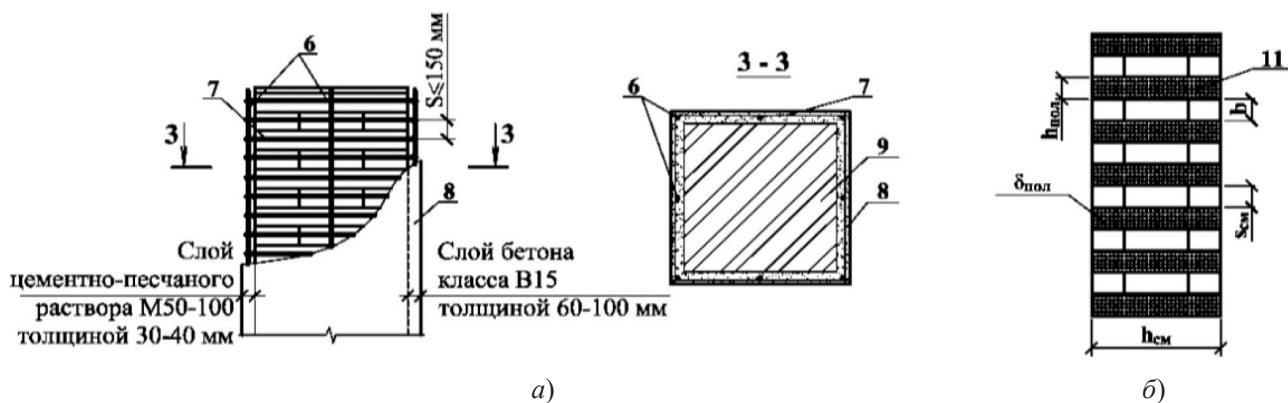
Усиление конструкций устройством обоймы: *a* – железобетонной и растворной; *б* – бандажами из углеволокна; 6 – вертикальная арматура обоймы; 7 – сварные хомуты обоймы; 8 – растворная или железобетонная обойма; 9 – усиливаемый каменный элемент; 11 – композитный материал из углеволокна [1]
